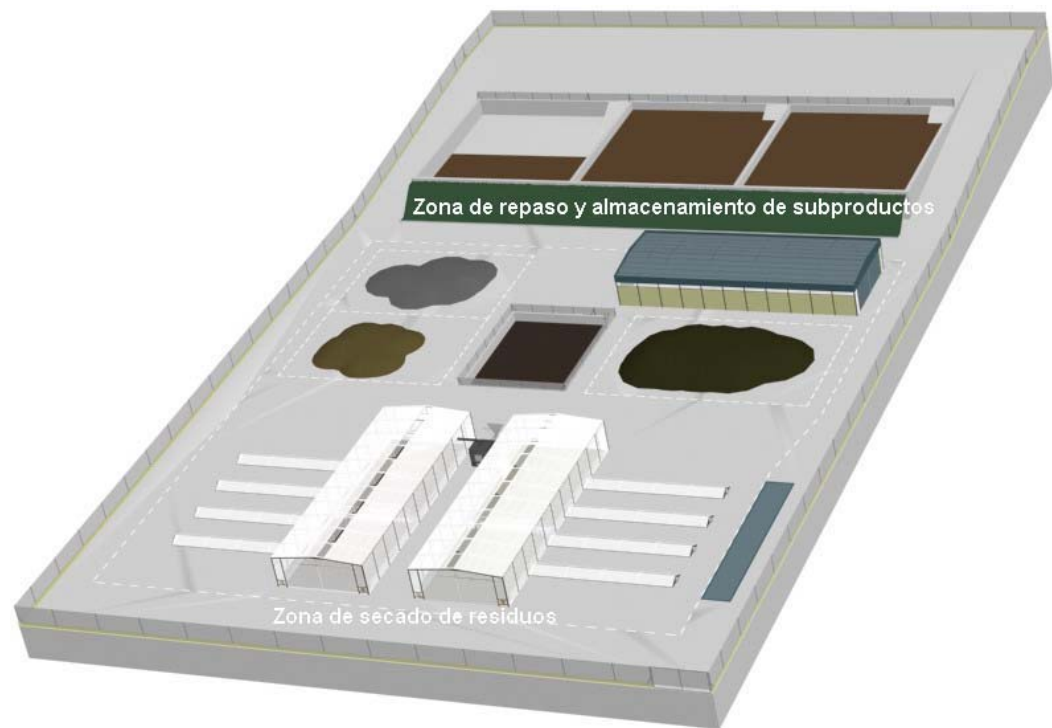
Distribución en planta de la instalación de tratamiento y secado de alperujos.
